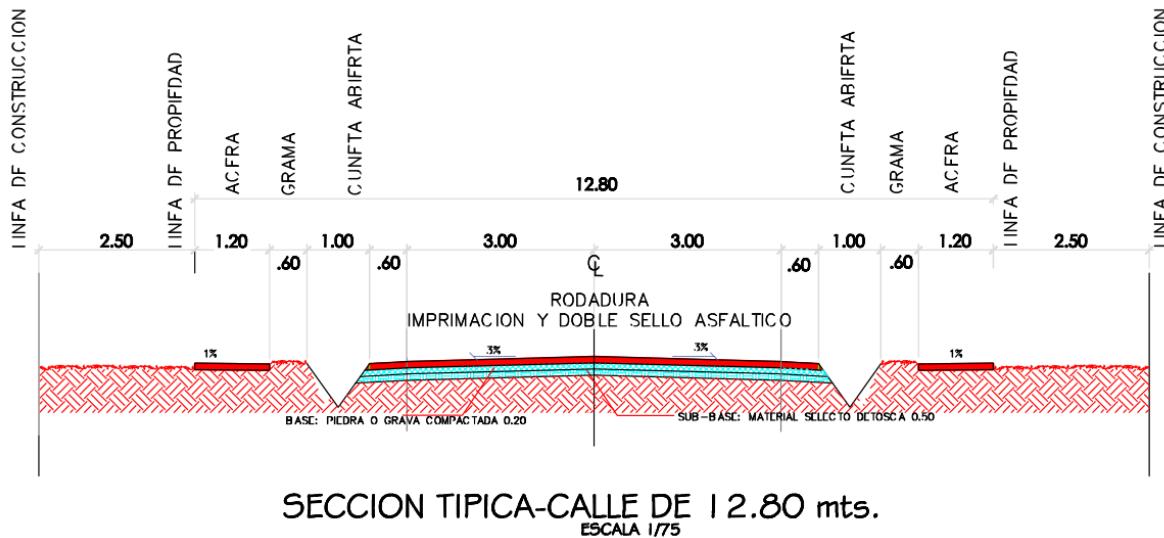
Esquema de las calles de 12.80 m de ancho. (Fuente: Anteproyecto)
